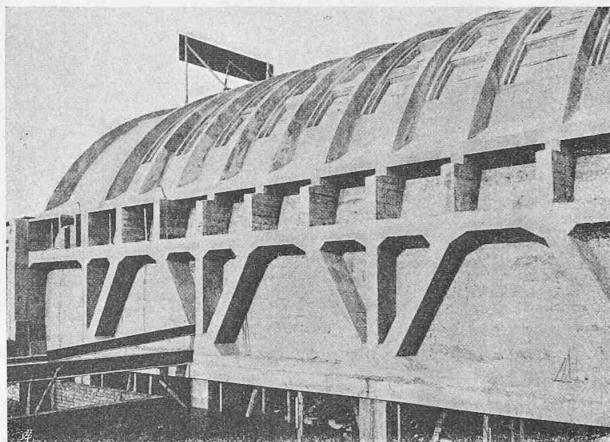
Rückansicht der fertig einbetonierten Schalterhalle.
